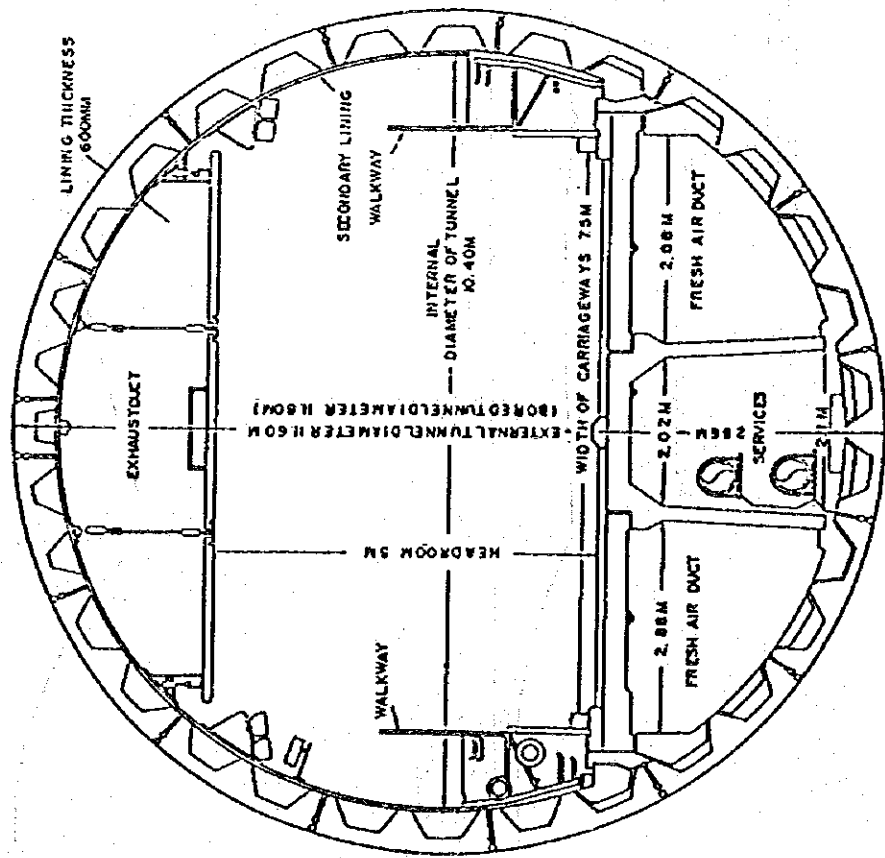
66 Ahmed Hamdi Tunnel の断面図
